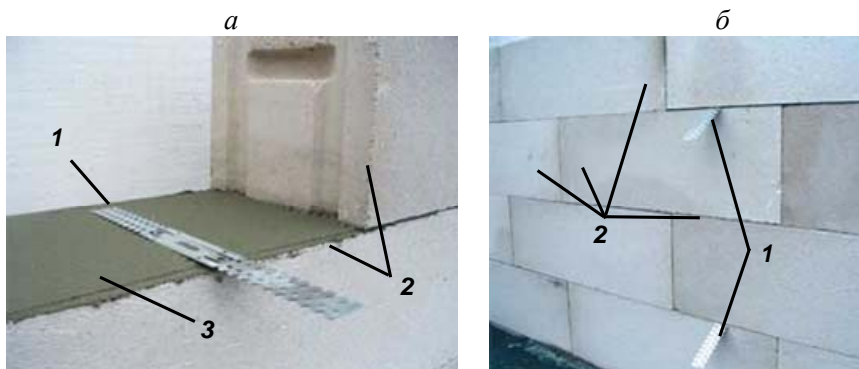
Крепление перегородок к несущей стене стальными анкерами:
